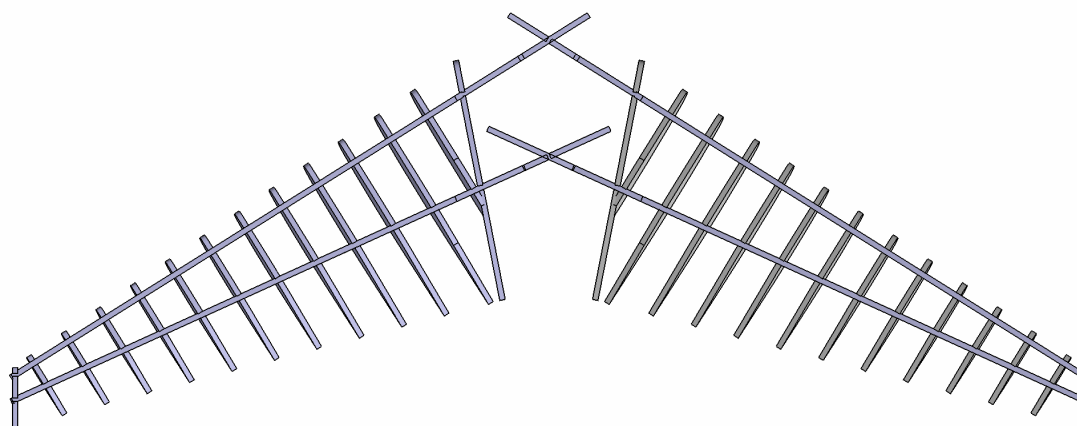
Vista en planta de les costelles i travessers de l'estabilitzador horitzontal de l'aeronau
